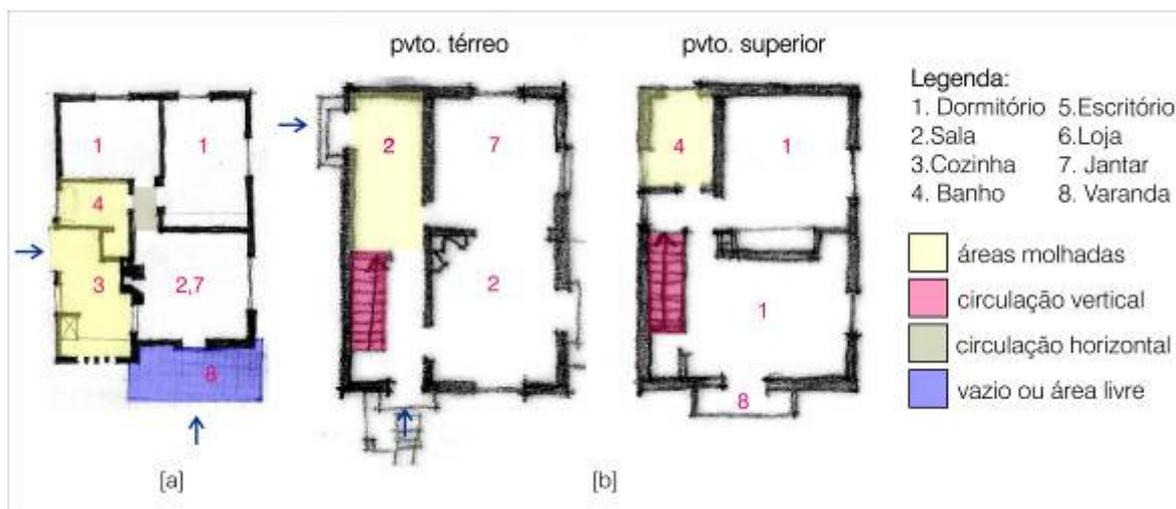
Planta e fachada da Fazenda Donnersmark.
